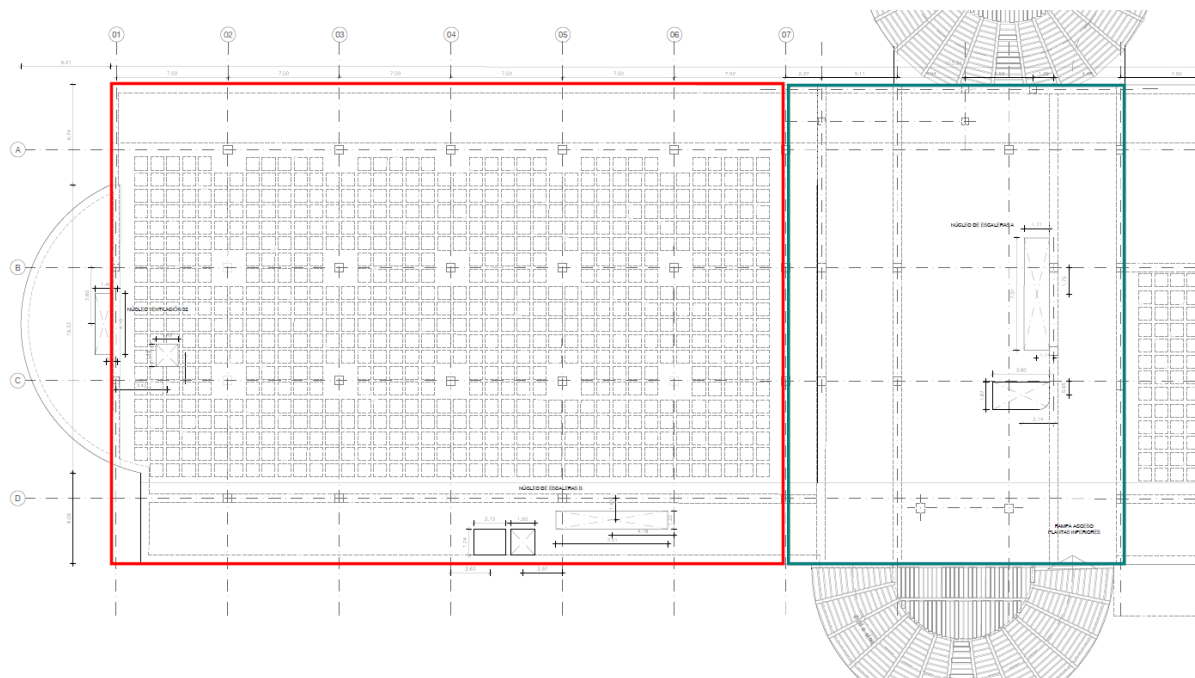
Localización en planta del forjado bidireccional (rojo) y unidireccional (verde).
